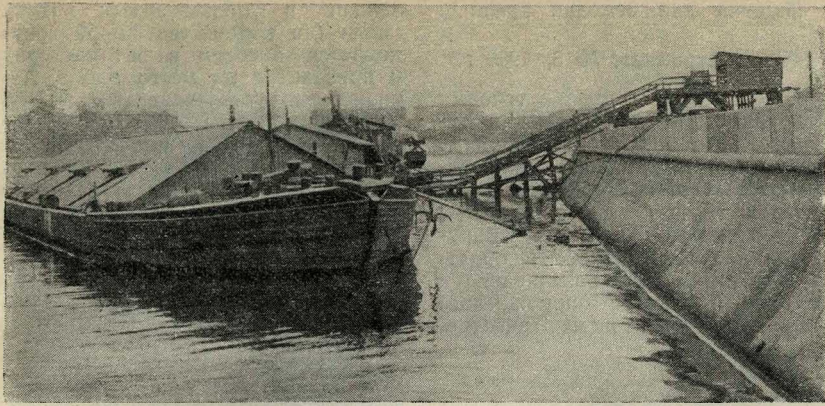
Пловучий бетонный завод для дорожных работ на проездах набережных
